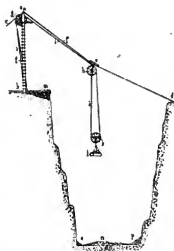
Erz- und Stein-Aufzug für Tagebau-Anlagen.
